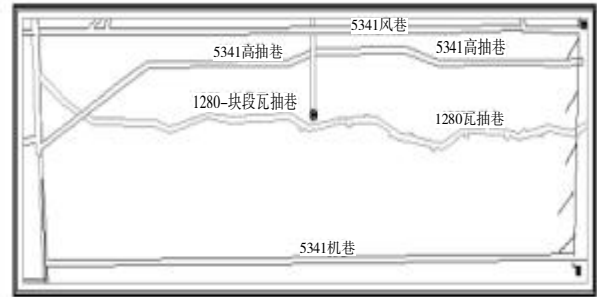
5341 综放回采工作面及其高抽巷布置的平面图
